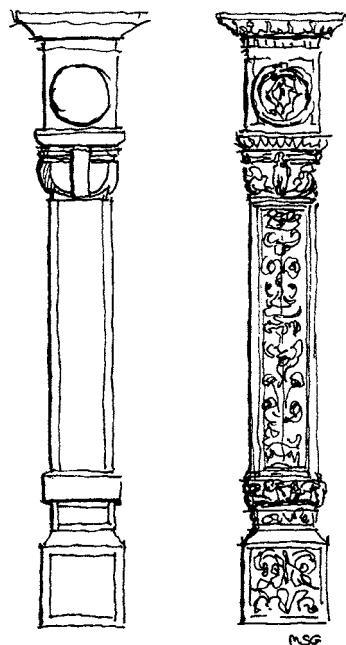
Comparación de pilastras en la fachada norte de la catedral de Plasencia, una labrada y otra sin labrar.
